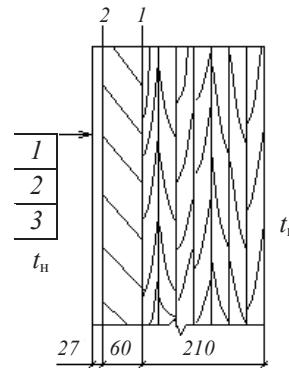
Конструкция стены из kleеного бруса с дополнительным утеплением:
